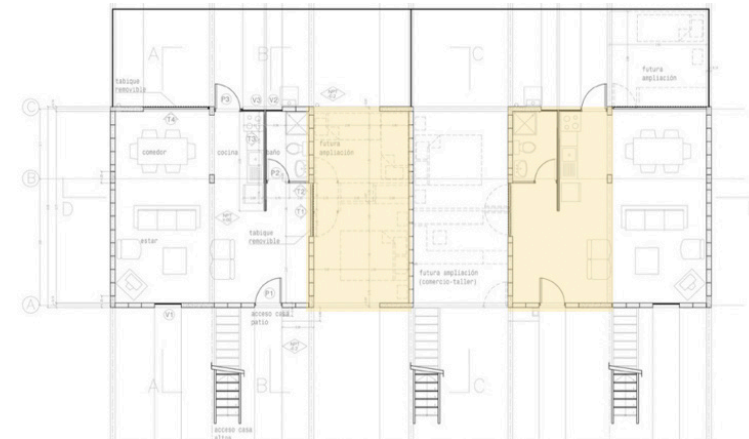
Quinta Monroy , Planta Arquitectónica I (Plataforma Arquitectura, 2007)
